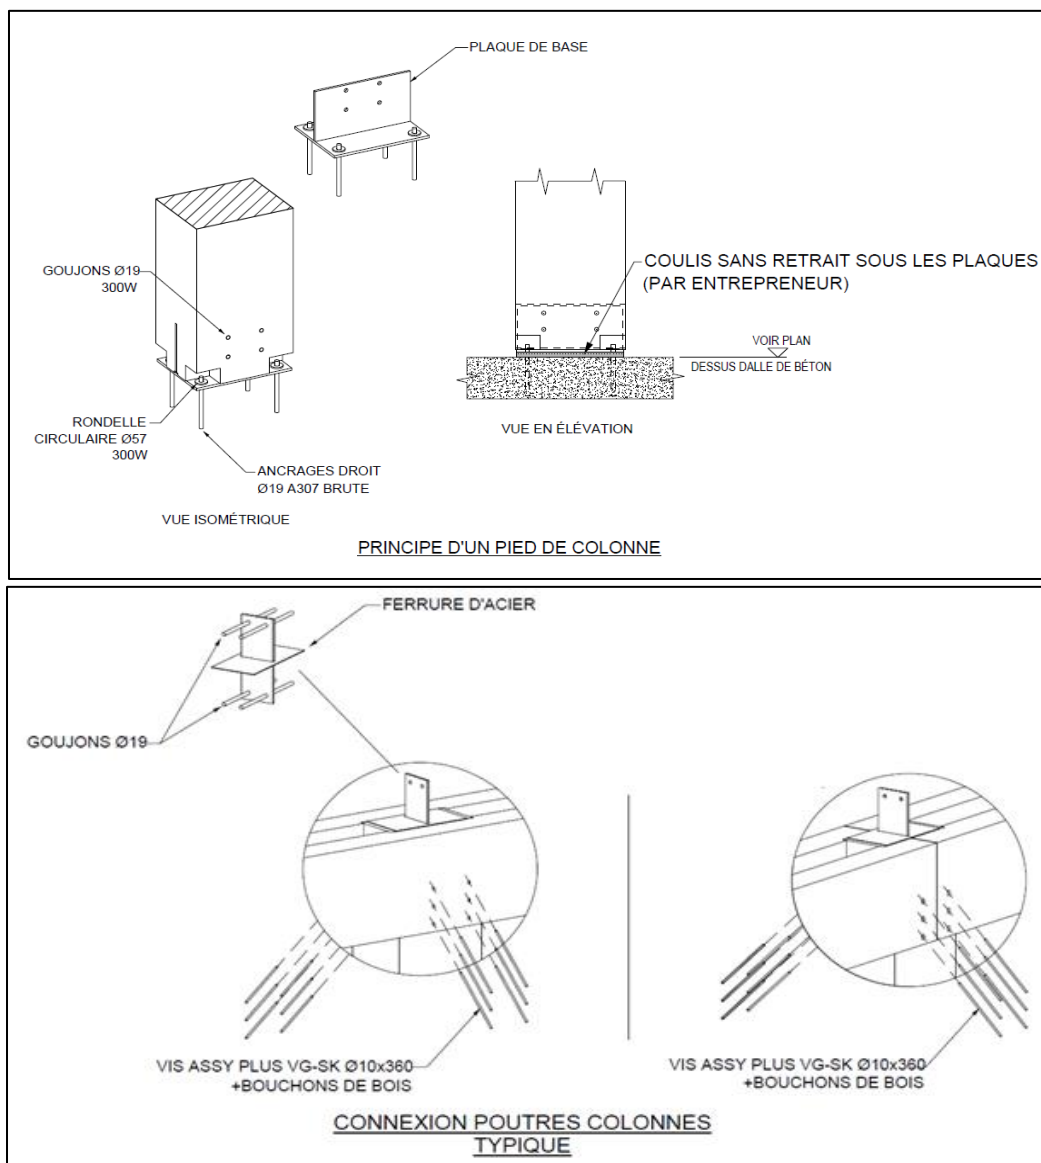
Détails de l'assemblage colonne-dalle (bois-béton) et poutre-colonne (bois-bois)
